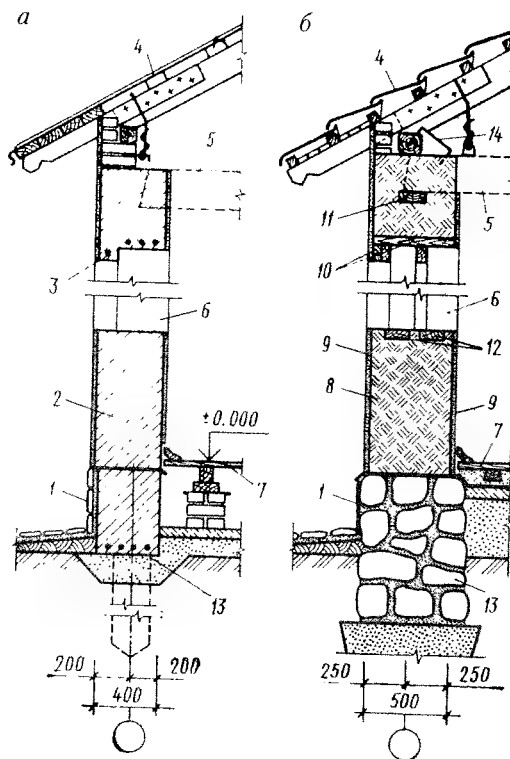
Разрезы наружных стен одноэтажных жилых домов из местных материалов:
